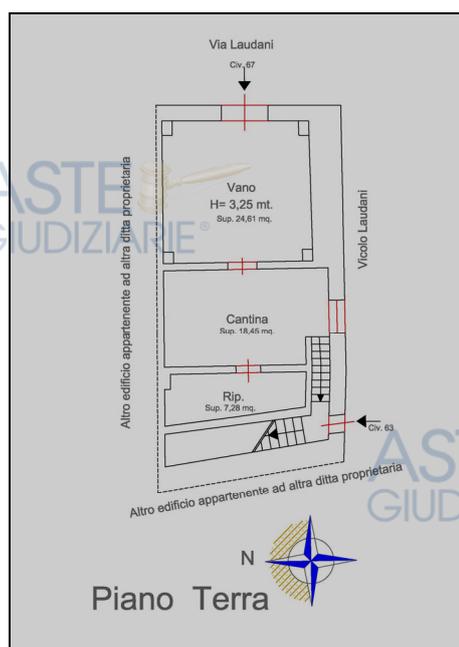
Visualizzazione della planimetria dell'immobile con indicazione delle superfici utili
